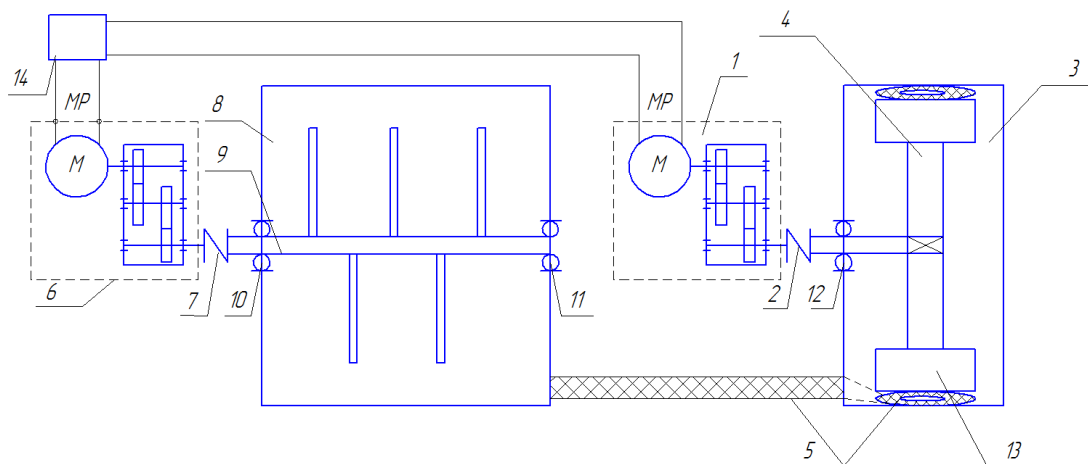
Кінематична схема безпоршневого універсального бетононасоса з механічним приводом:
